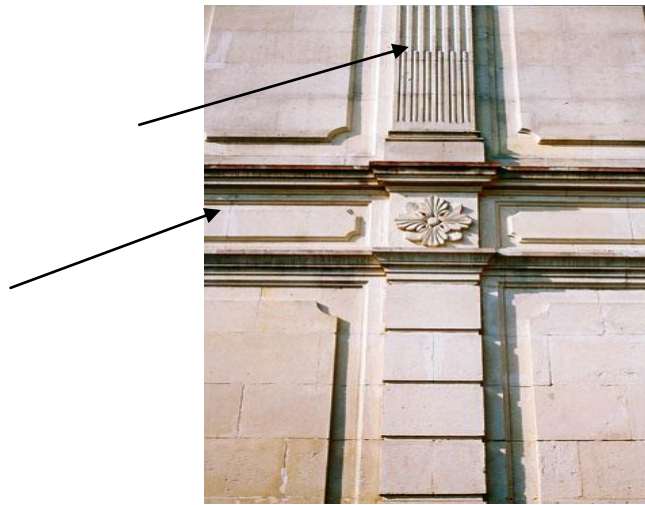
Croisement d'un Bandeau verticale et un horizontal.
